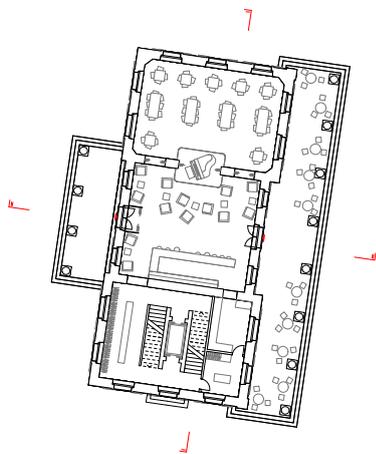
Grundriss Erdgeschoss Sommercasino 1:600
